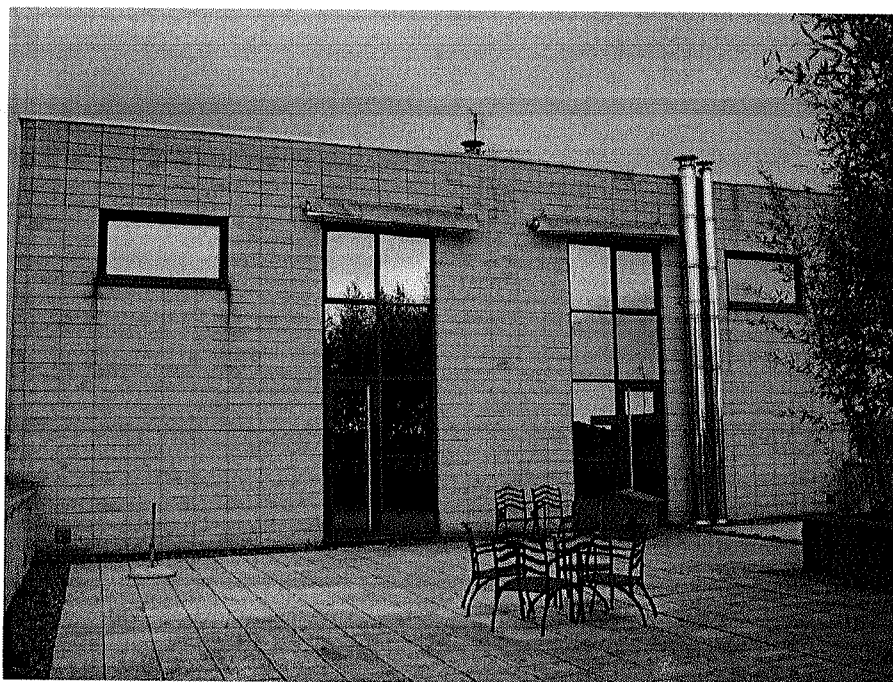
Vista esterna: fronte ovest dal piano secondo
